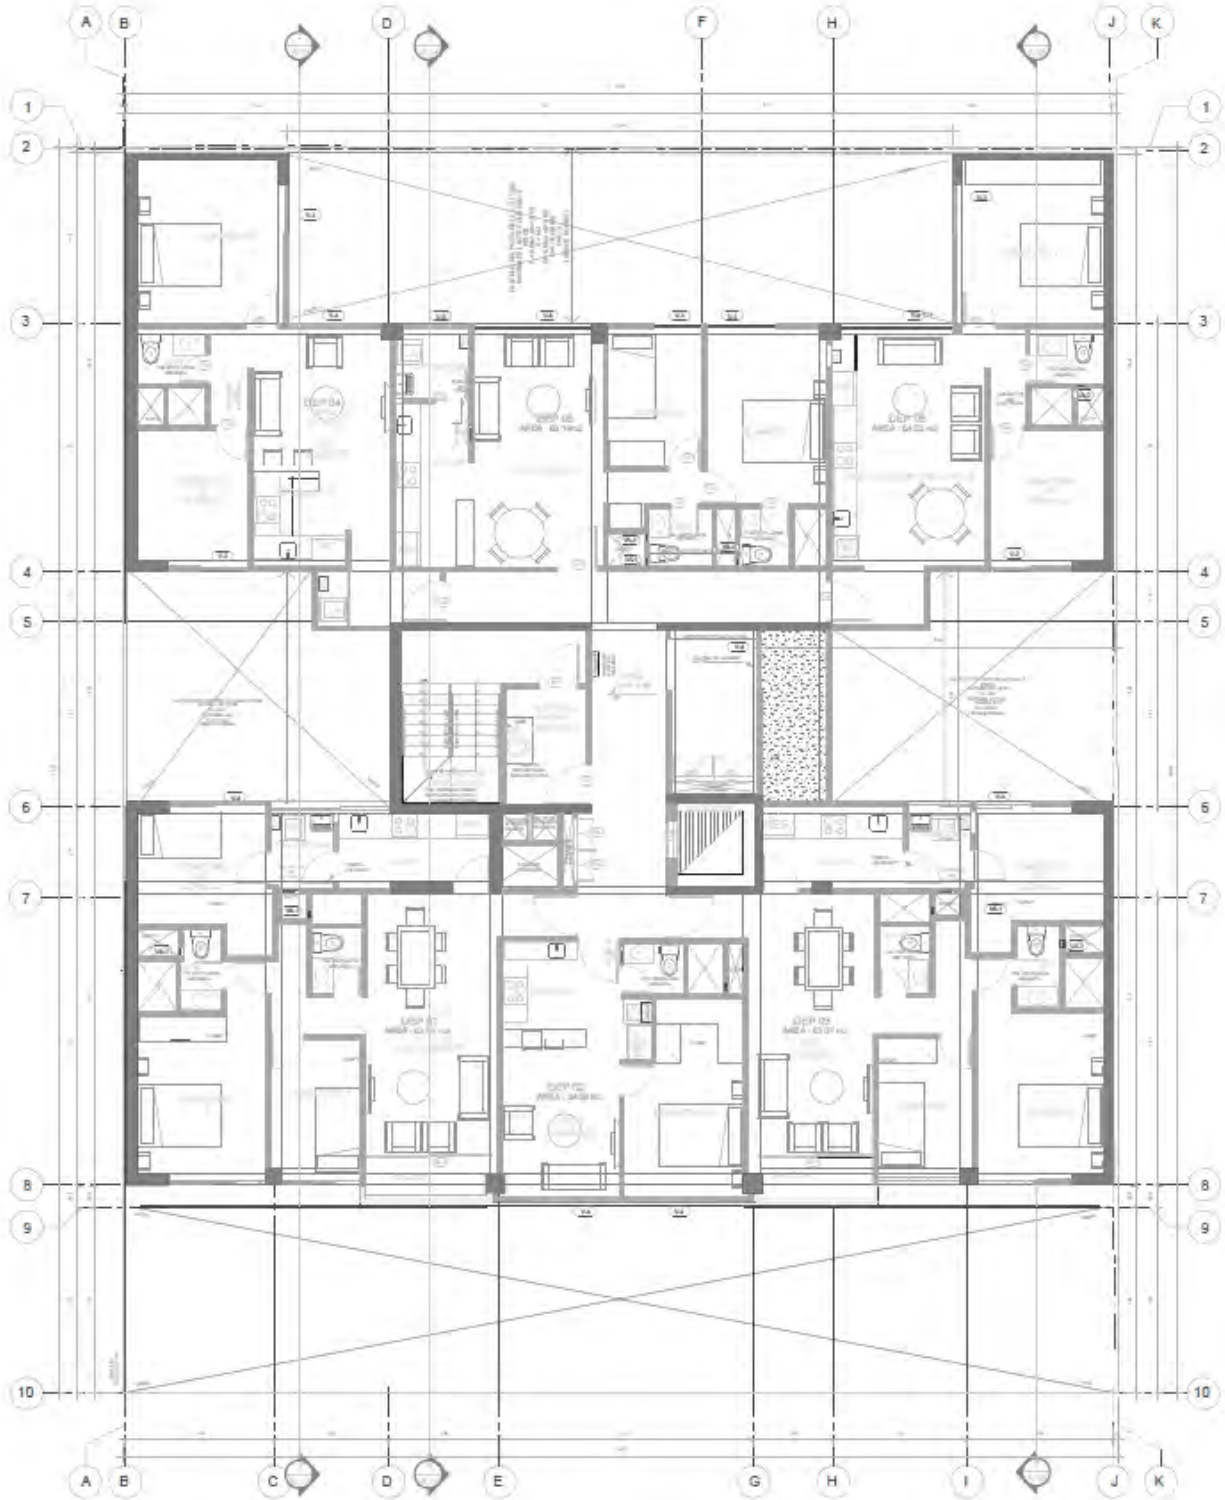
PLANTA DEL PISO TÍPICO
